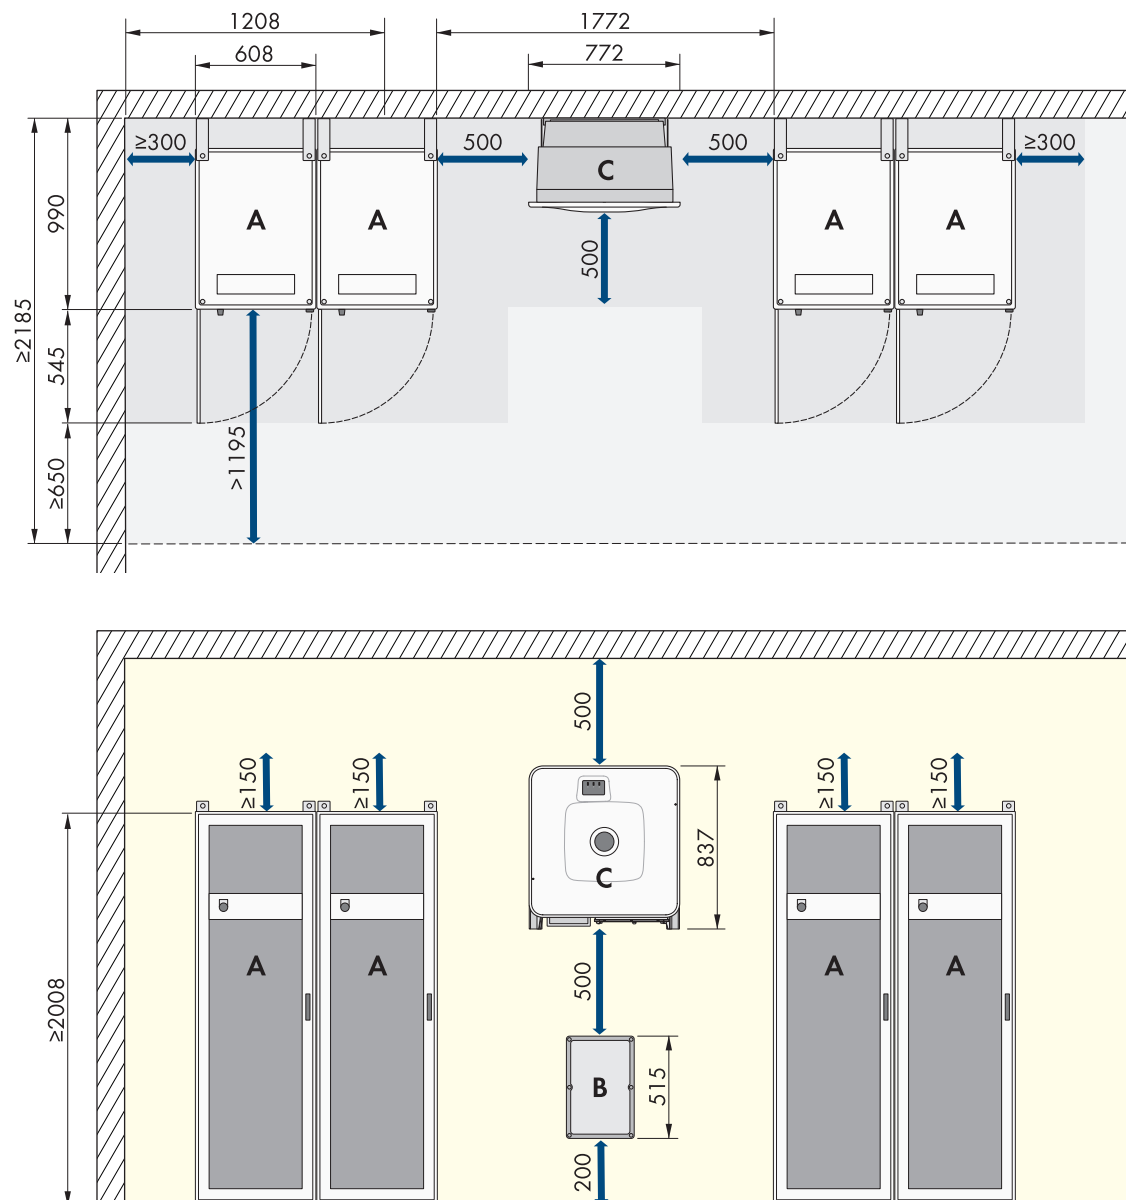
Exemple d'implantation d'un système avec 4 armoires de batteries
